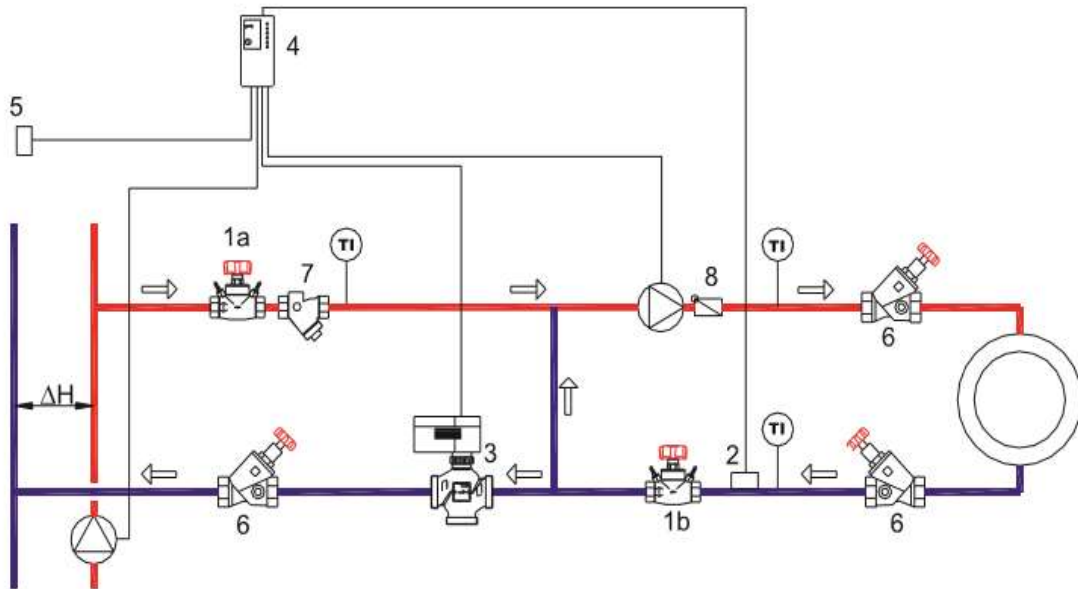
Okruh se směřováním v pevném bodě s předúpravou
